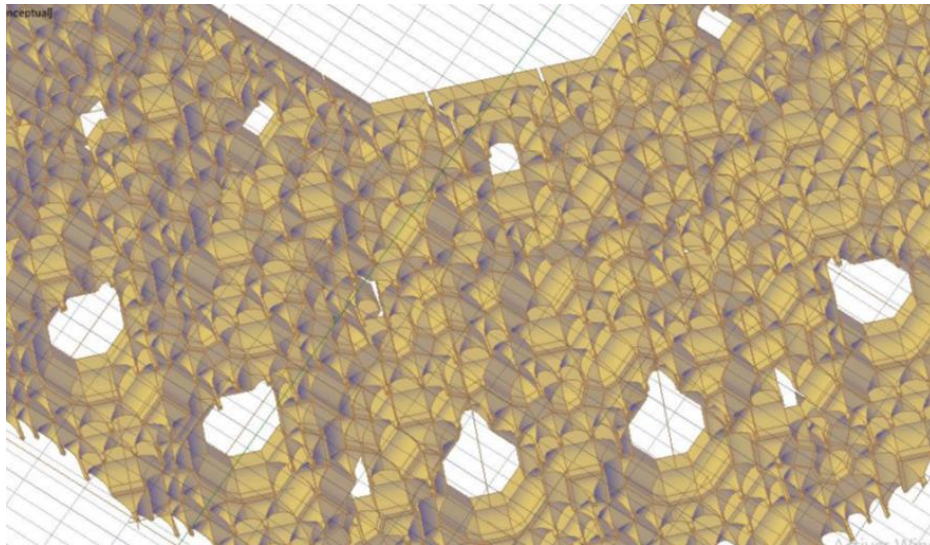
Elévation en 3D de la coupole de la salle des deux sœurs à Alhambra d'après plan Fig 12/AUTEUR
